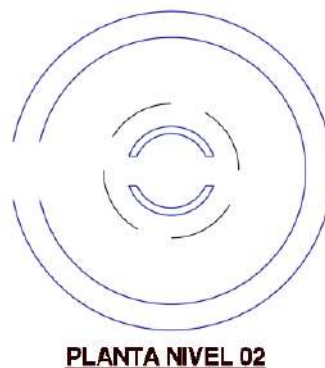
Planta del segundo nivel. (Fuente Autor)
